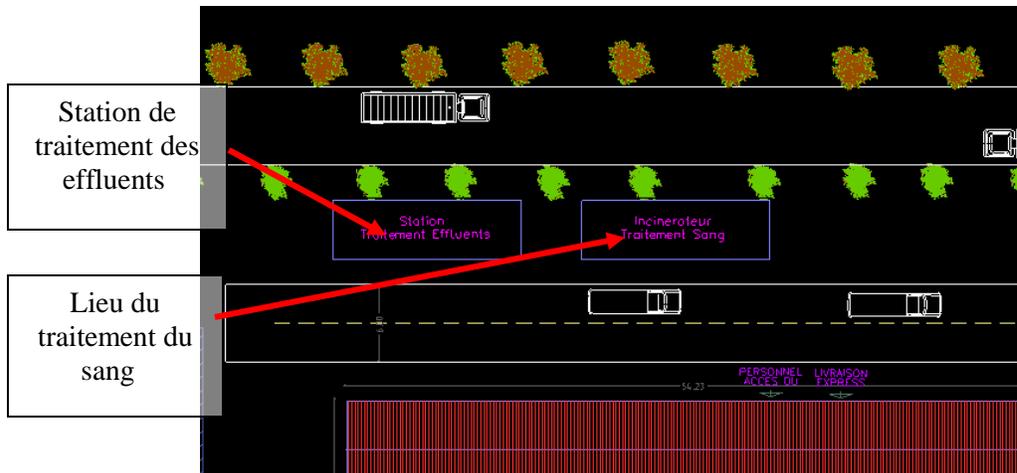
Station de traitement des effluents et lieu du traitement du sang sur notre plan architectural.
